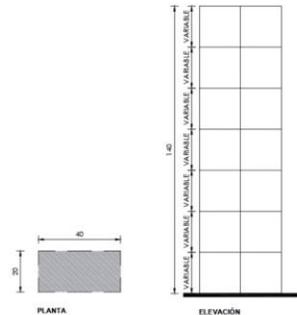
Vistas en planta y elevación del edificio, acotaciones en cm
